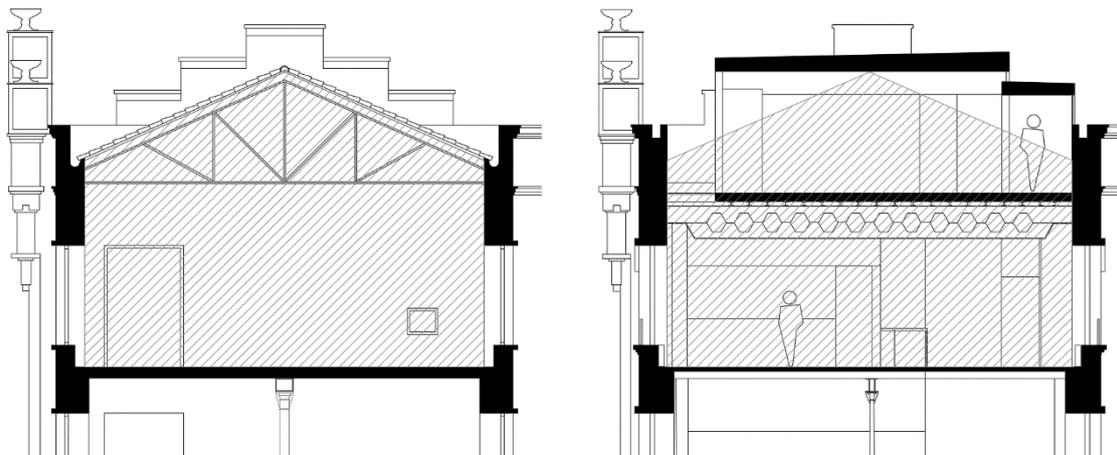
Volumen bajo cubierta: Estado original / Estado después de la rehabilitación.
